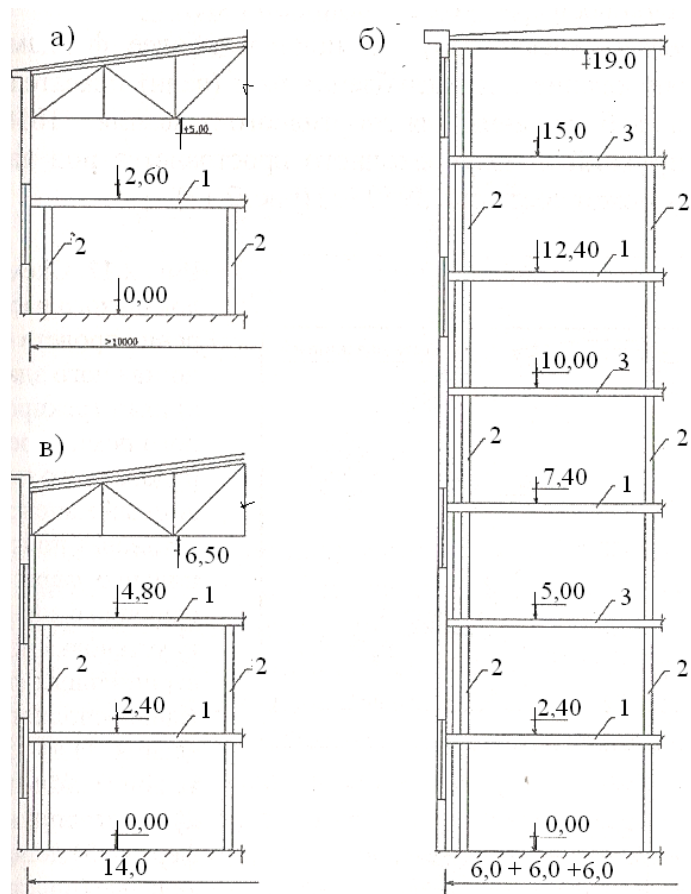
Схемы размещения дополнительных перекрытий в промышленных зданиях: а, в - в одноэтажных зданиях различной высоты; б - в многоэтажных зданиях каркасного типа; 1- дополнительное перекрытие, 2- дополнительные опоры, 3- основное перекрытие
